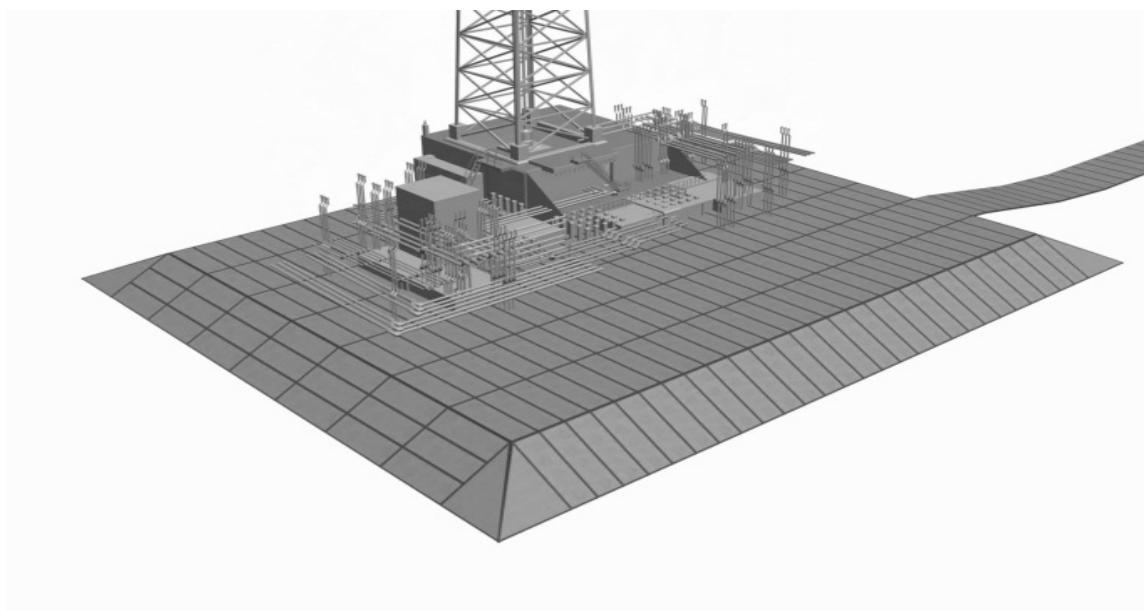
Буровая площадка на основе свайно-эстакадной конструкции с покрытием сталепетроситалловыми плитами
